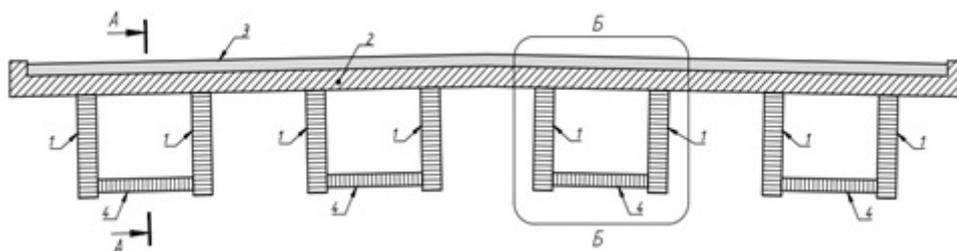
Деревобетонное пролетное строение с балками из клееной древесины заводского изготовления.
